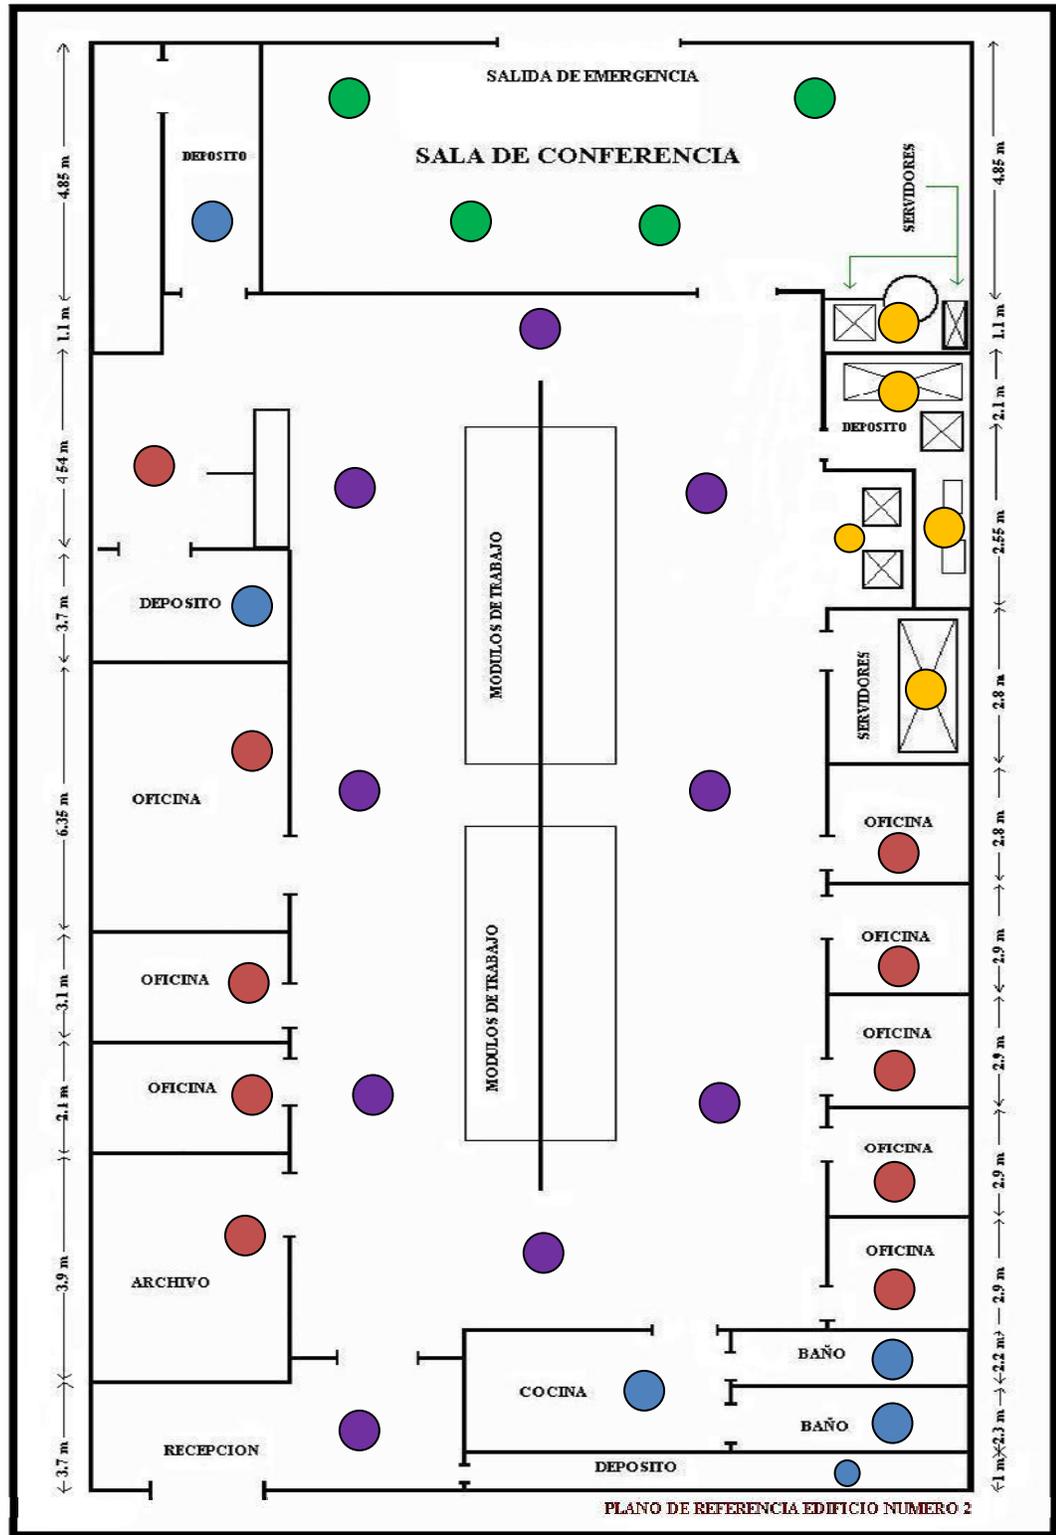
Plano de la Distribución de Zonas Edificio Nro.2
